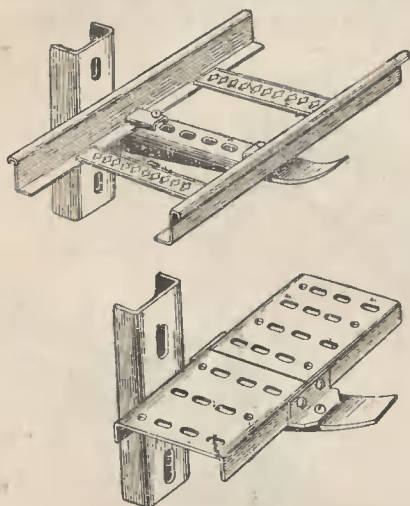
Крепление сварных и перфорированных лотков на кабельных полках.
